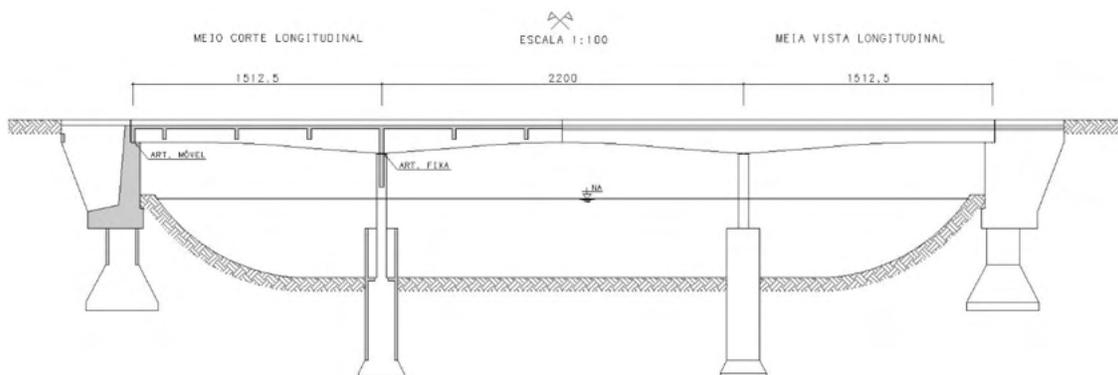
1/2 Vista e 1/2 Corte Longitudinal.
